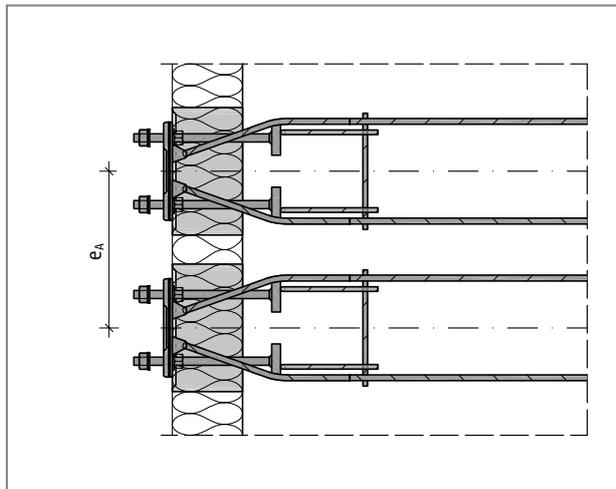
Schöck Isokorb® XT Typ SQ: Achsabstand
